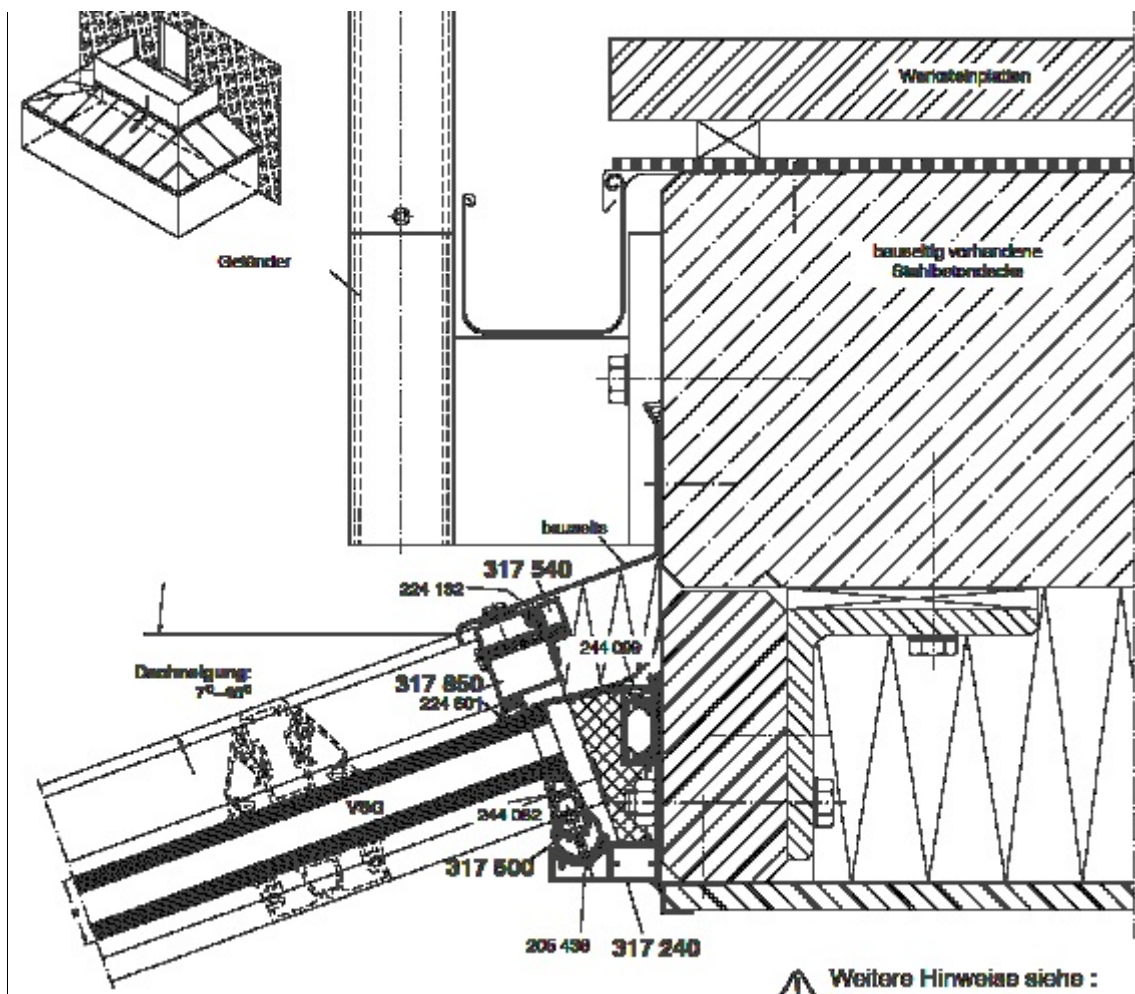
Wandanschluss vor Balkonplatte, SCHÜCO WA 60 3-6, 6.2002
